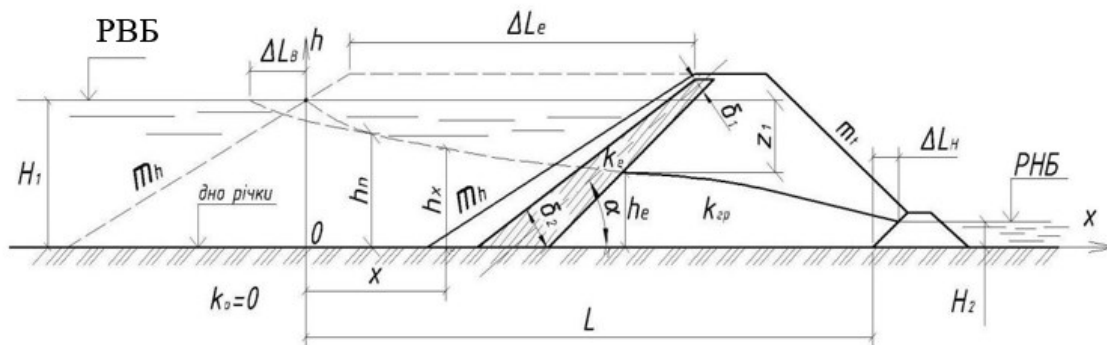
Розрахункова схема для греблі з екраном на дренажним банкетом на водонепроникній основі
